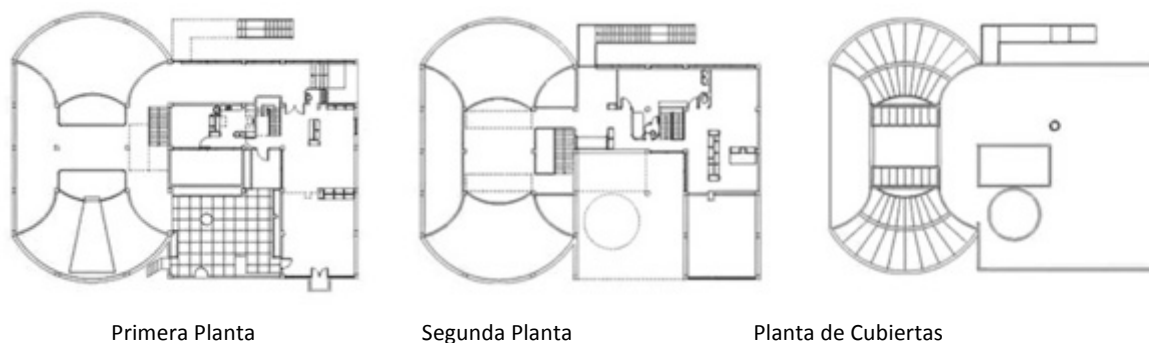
Plantas del Pabellón de *Pabellón L' Esprit Nouveau*. 1925
